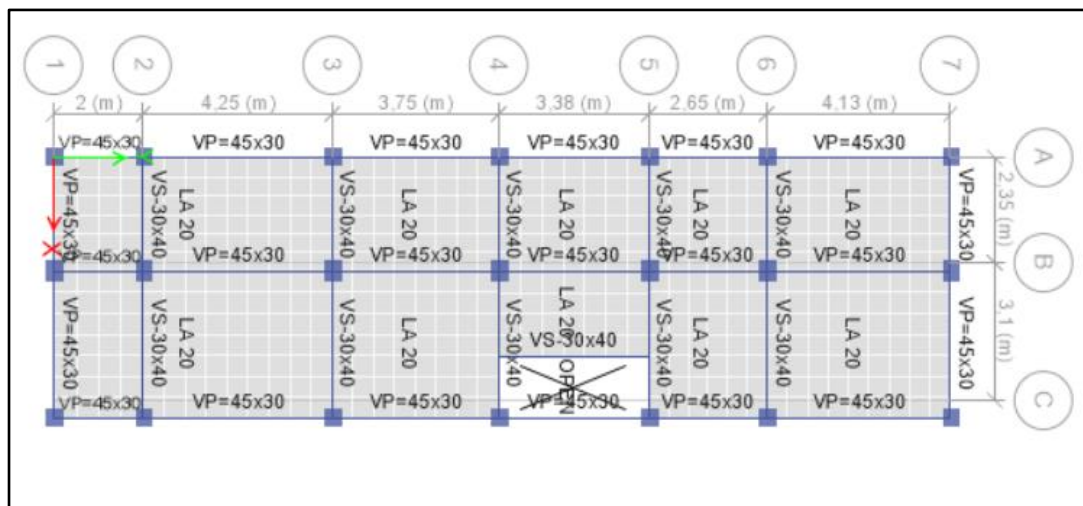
Plano con los Elementos Estructurales en el Edificio A (Etabs)
